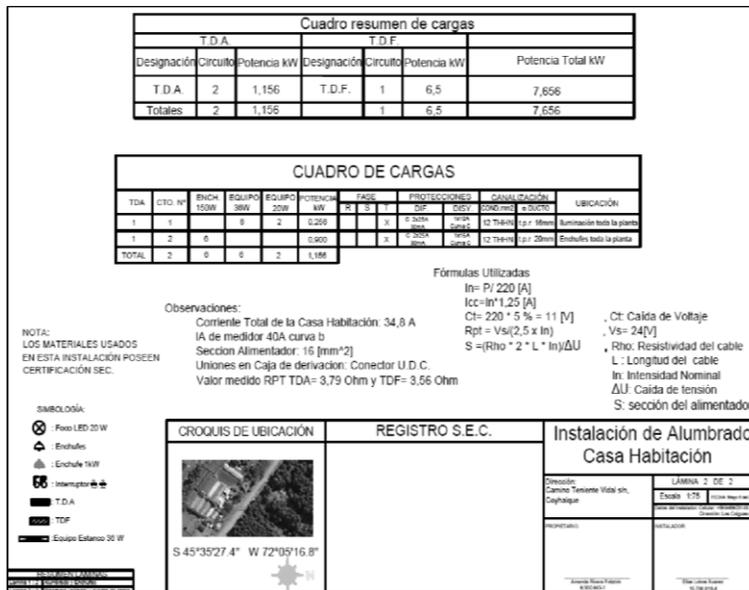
Plano eléctrico de la planta de procesos lamina B. Detalle del cuadro de cargas y potencia declarada.
